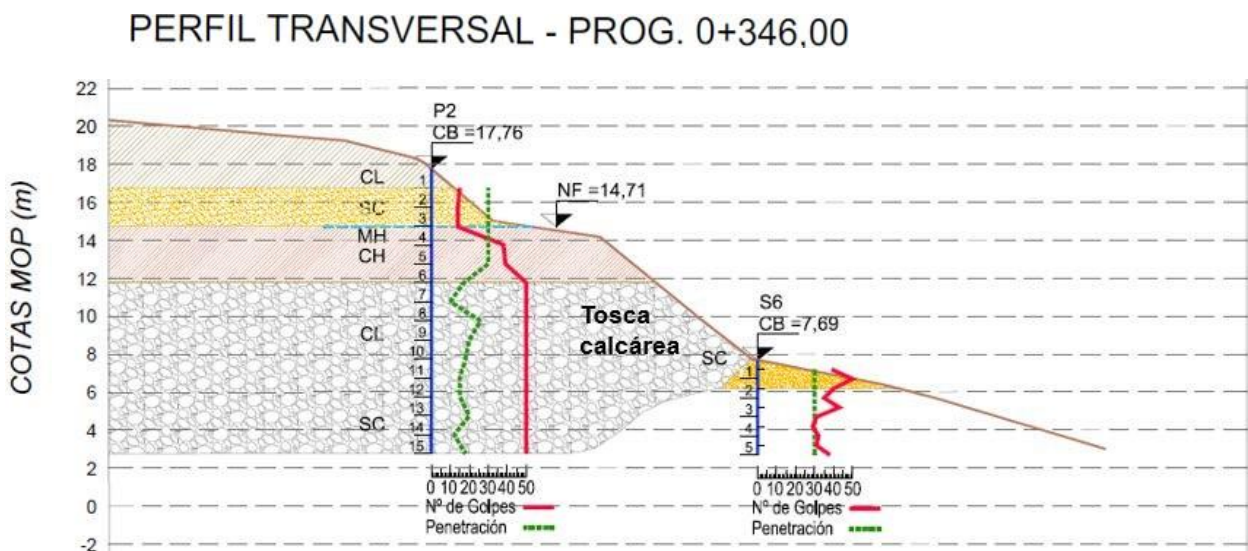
Perfil geotécnico en la zona del Pozo 2
